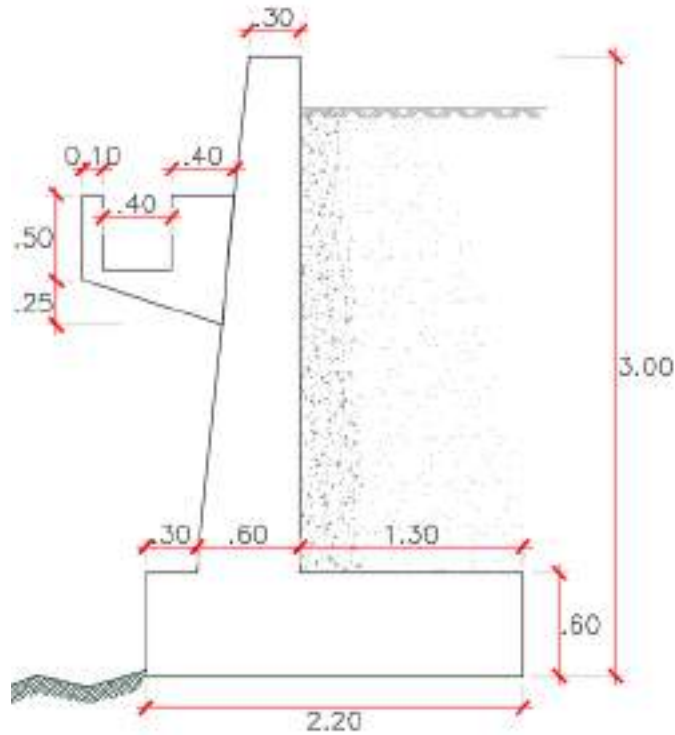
Dimensionamiento de muro en voladizo H=3.00m y canal de riego
